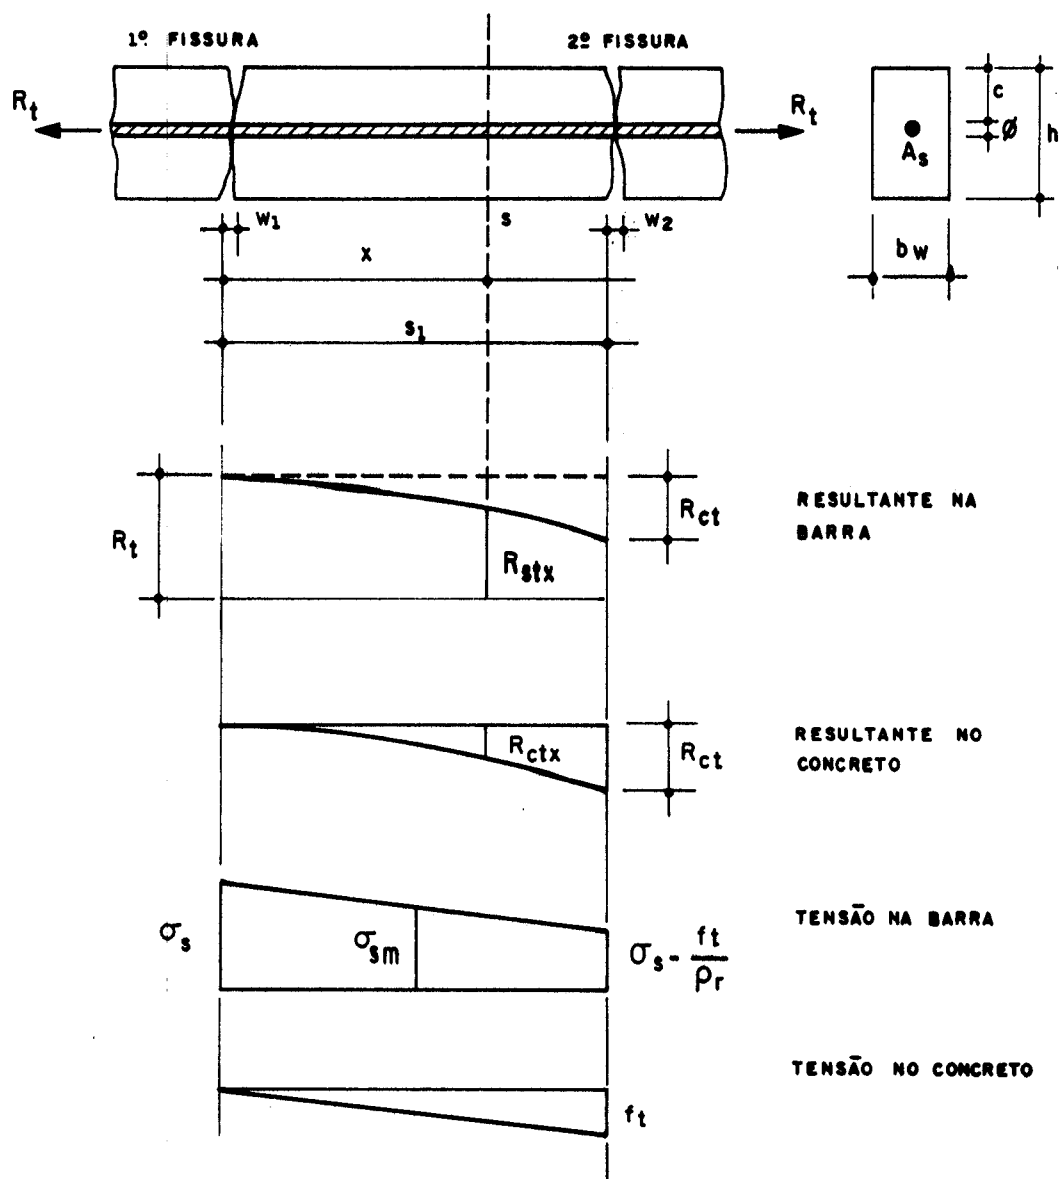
FISSURAÇÃO SISTEMÁTICA - MOLLICA JUNIOR⁵³
